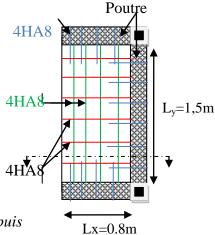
Schéma de ferraillage de la dalle sur 3 appuis
